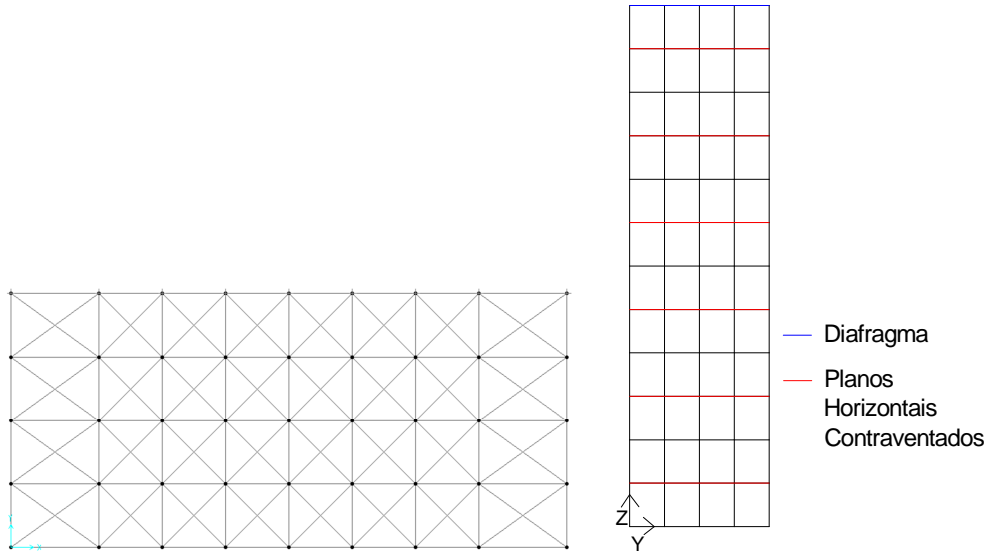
Configuração dos Planos de Contraventamento Horizontal Com Elementos de Contraventamento Pequenos
